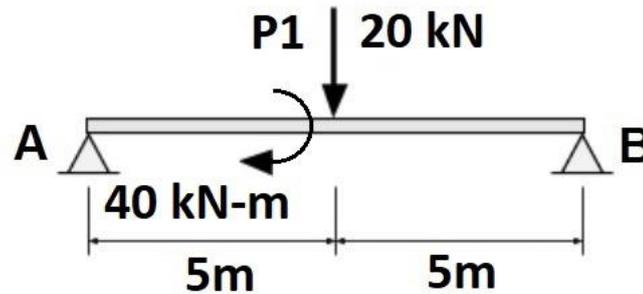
Esquema de una viga simplemente apoyada, que tiene aplicado sobre su centro el peso de un objeto.
